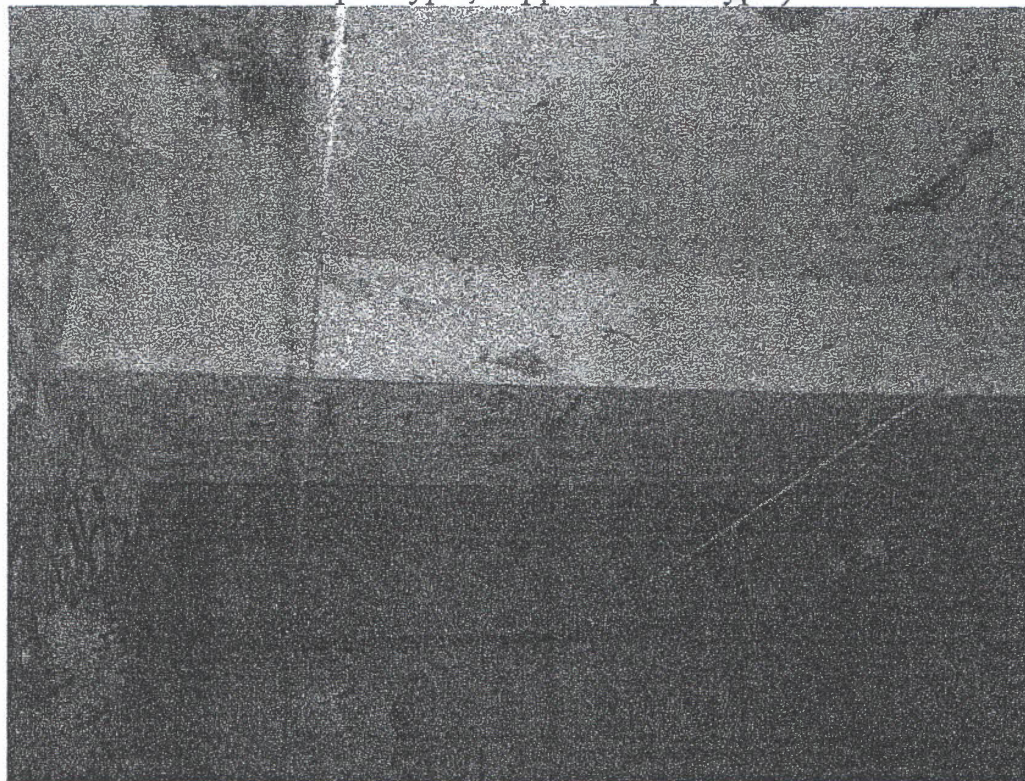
(3 этаж перекрытие над душевой, следы протечки, грибка, разрушение штукатурного слоя)
